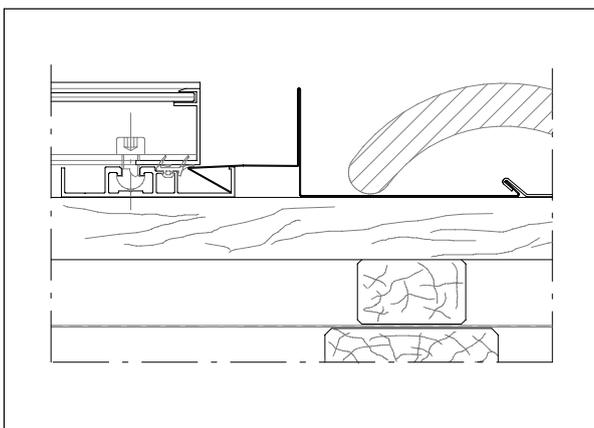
Chevauchement des tuiles sur la tôle de recouvrement
